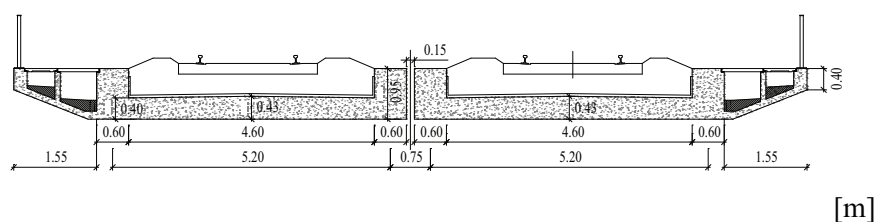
Corte transversal da ponte de São Lourenço.
